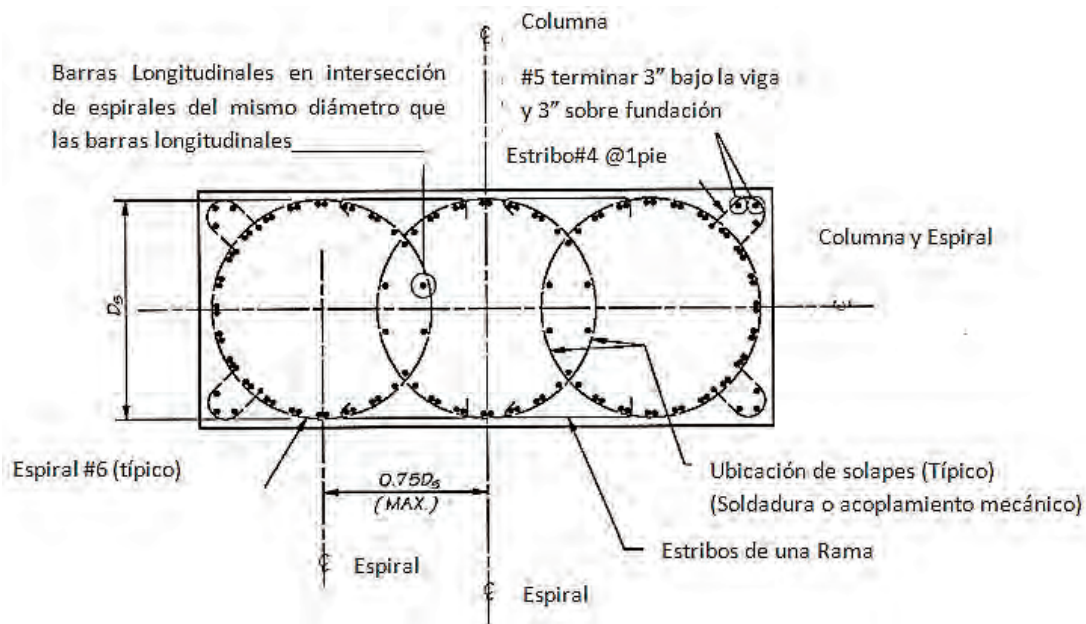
Columnas entrelazadas con refuerzos adicionales en las esquinas de la sección rectangular. (Fuente: WSDOT, 2014)
